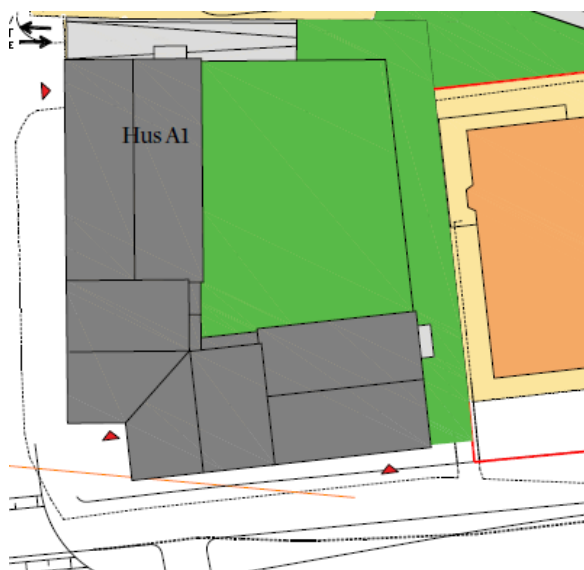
Planlösning enligt översiktsplan, Björknäs 1:427
